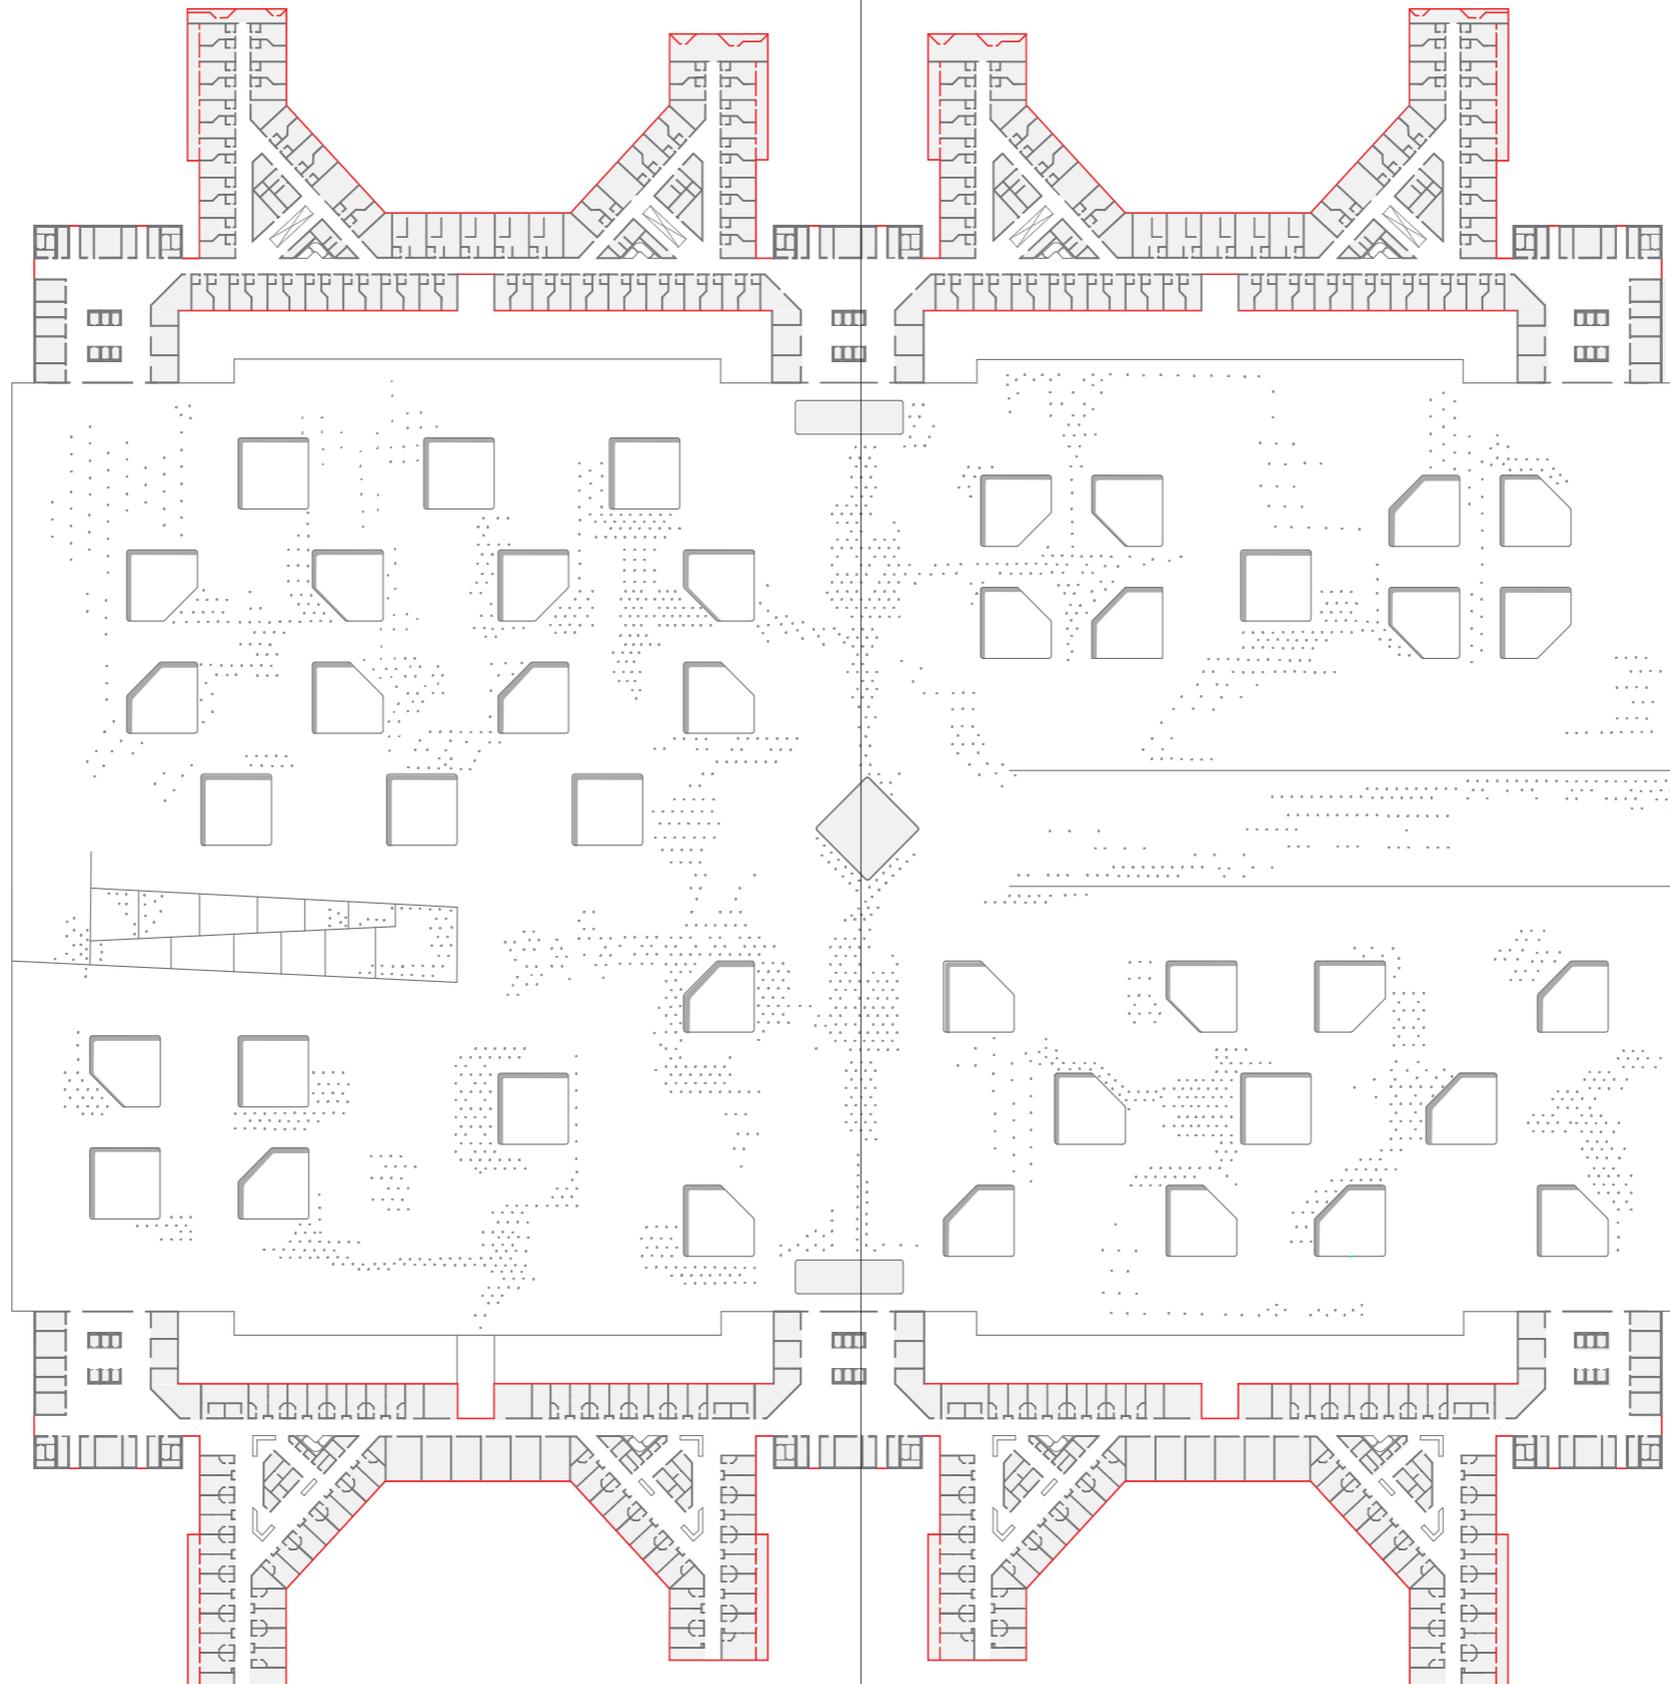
Grundriss 1. Obergeschoss, M.1:1500
